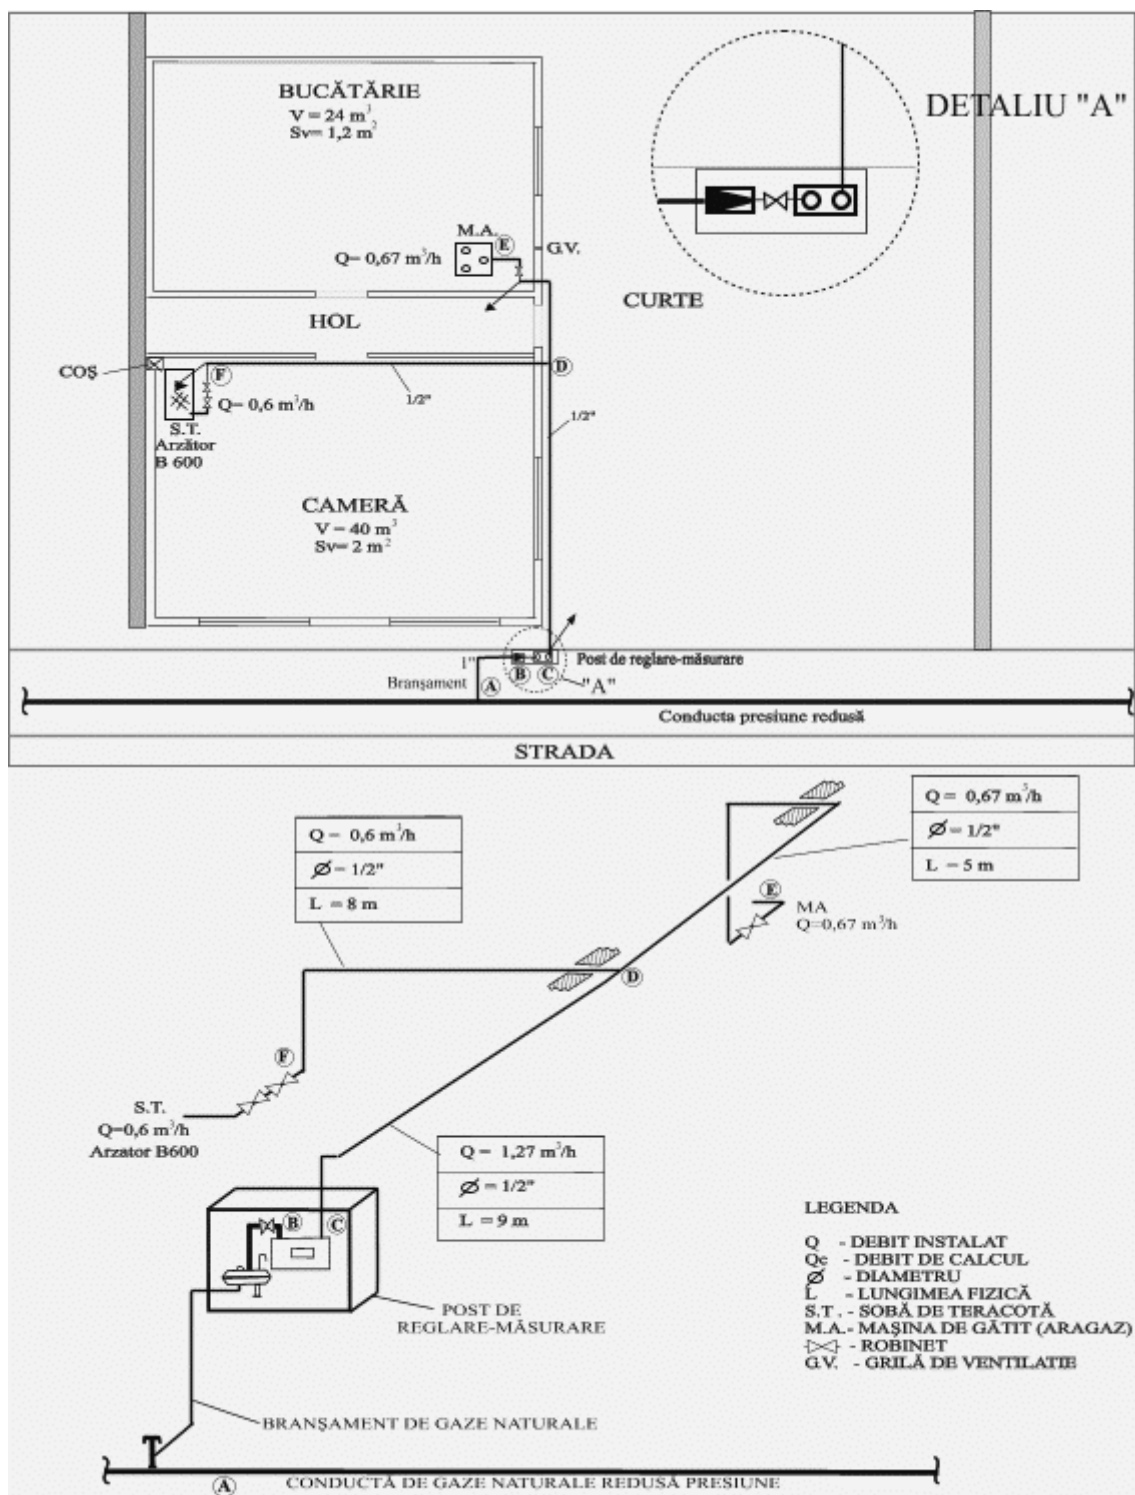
Plan și schemă izometrică pentru instalație de utilizare neindustrială a gazelor naturale (exemplu)
